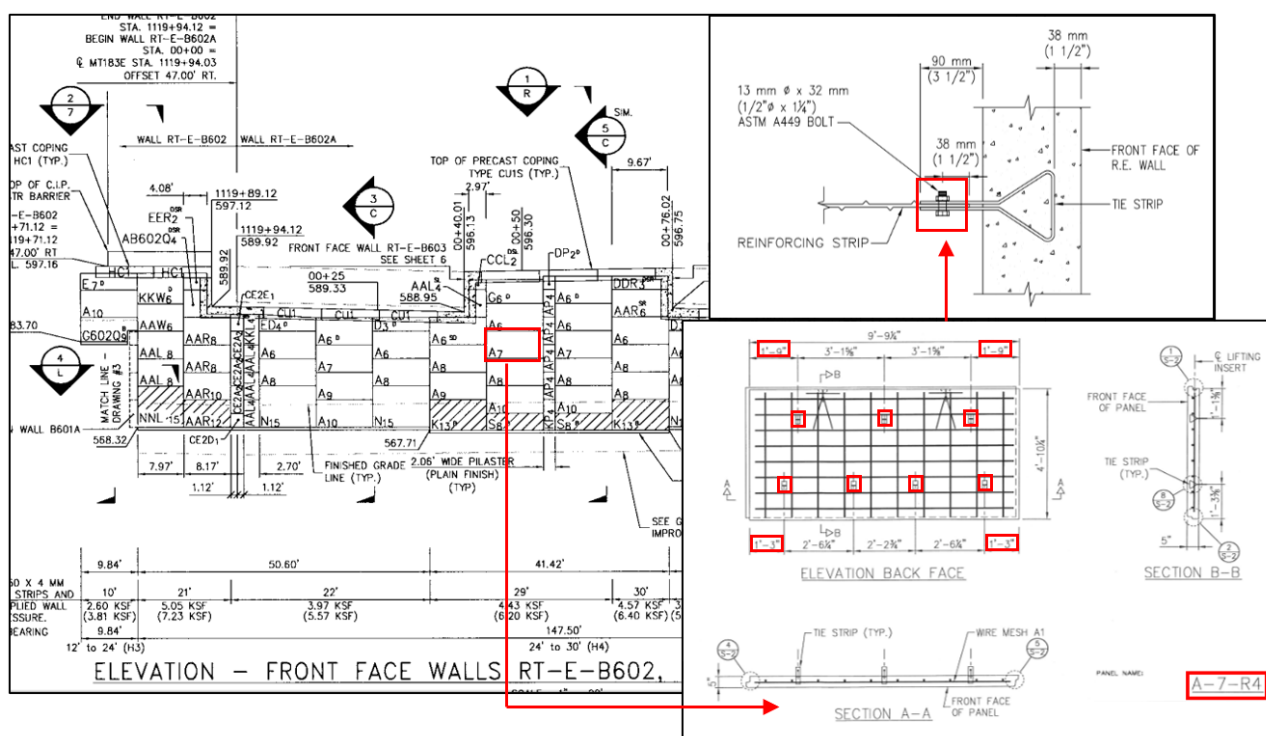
Ejemplo de una escama (A7) del muro construido y sus detalles.
